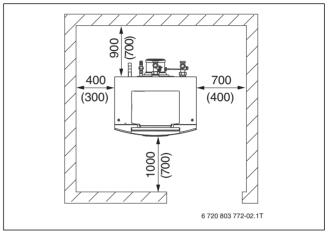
Wandabstände im Aufstellraum: Empfohlene und minimale Wandabstände (in Klammern, alle Maße in mm)
